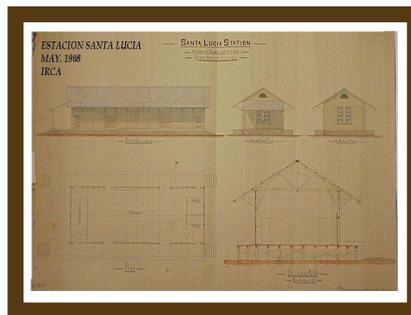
Plano de la Estación Original de Santa Lucía Cotzumalguapa, 1908
